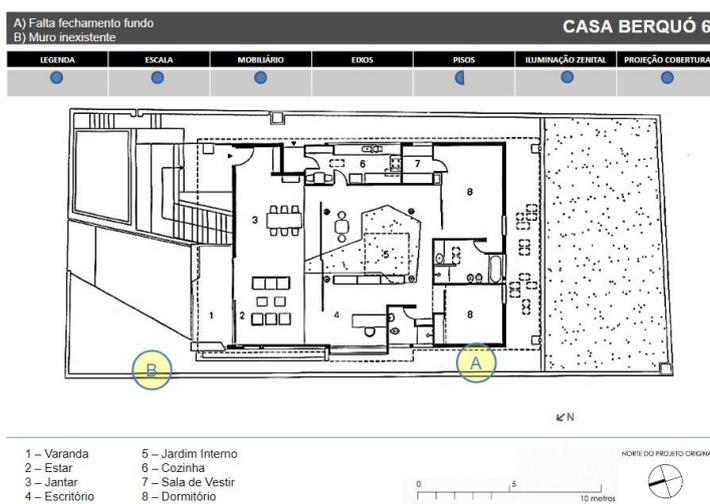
Planta do *piano nobile* da casa Berquó, 2000/2010
